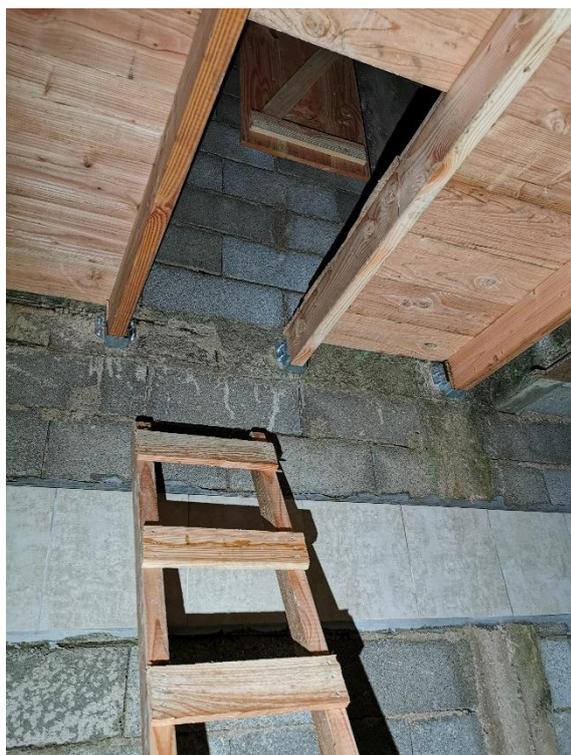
PLANCHER EN BOIS CREE POUR ACCEDER AU
